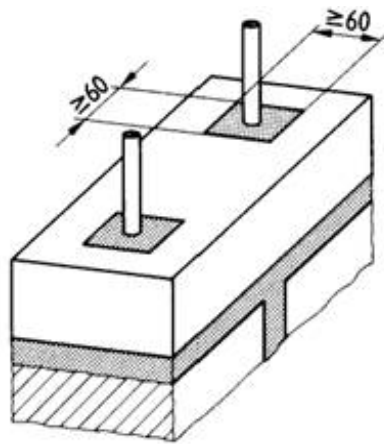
Vertikale Bewehrung in Formsteinen mit kleiner Ausparung.
